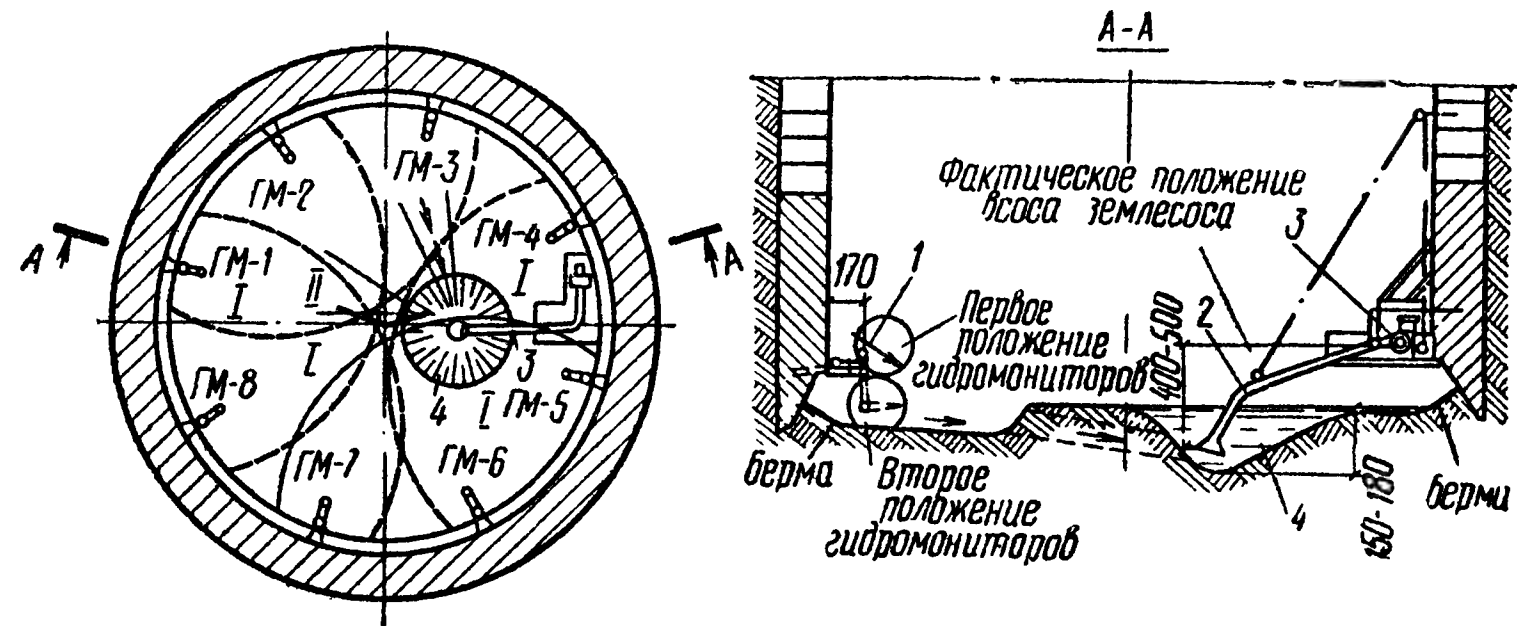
Схема разработки грунта в опускном колодце с применением землесоса, размещенного на консоле стены колодца
